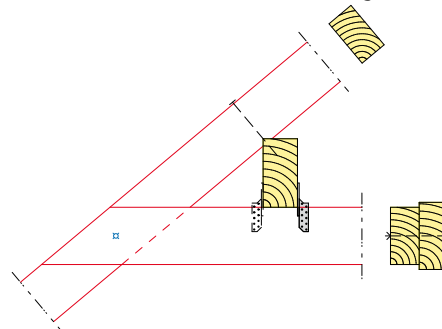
Kehlbalkenanschluss mit Pfette oberhalb
